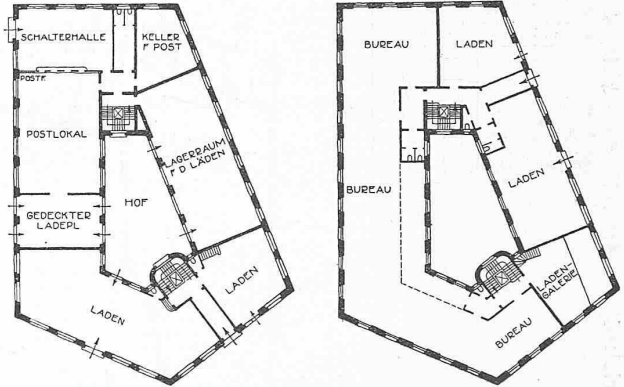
und 21. Grundrisse des Geschäftshauses. — 1 : 800.
